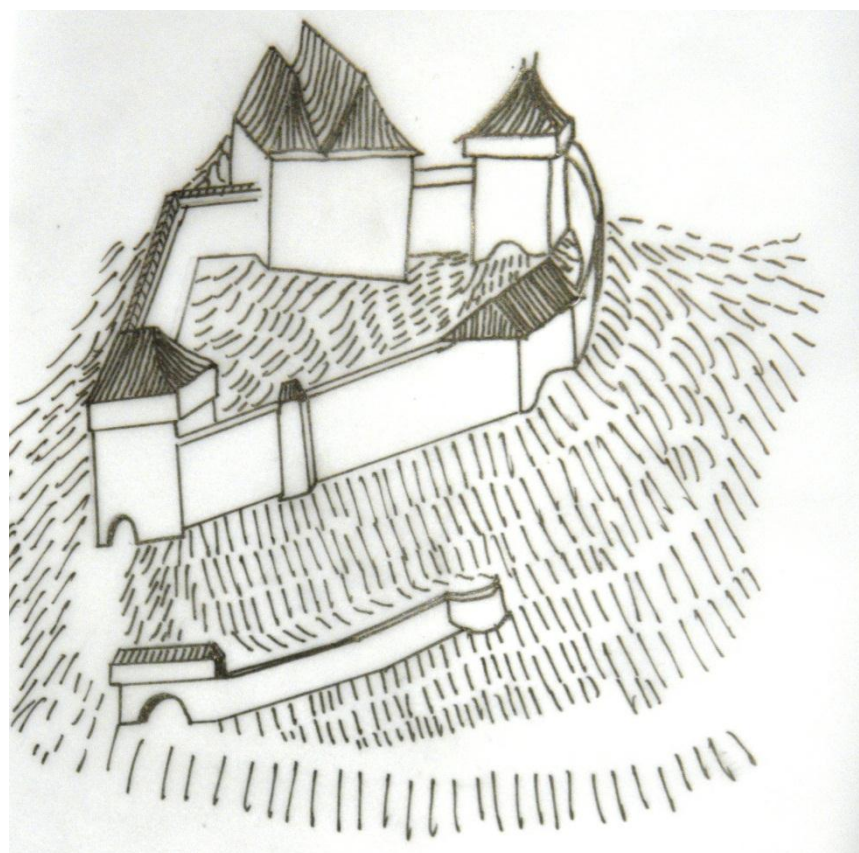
, 33: nahoře: plán druhé stavební fáze hradu. Kresba autor dle plánu D. Menclové. Následující stránka: hmotová rekonstrukce. Kresba autor.
